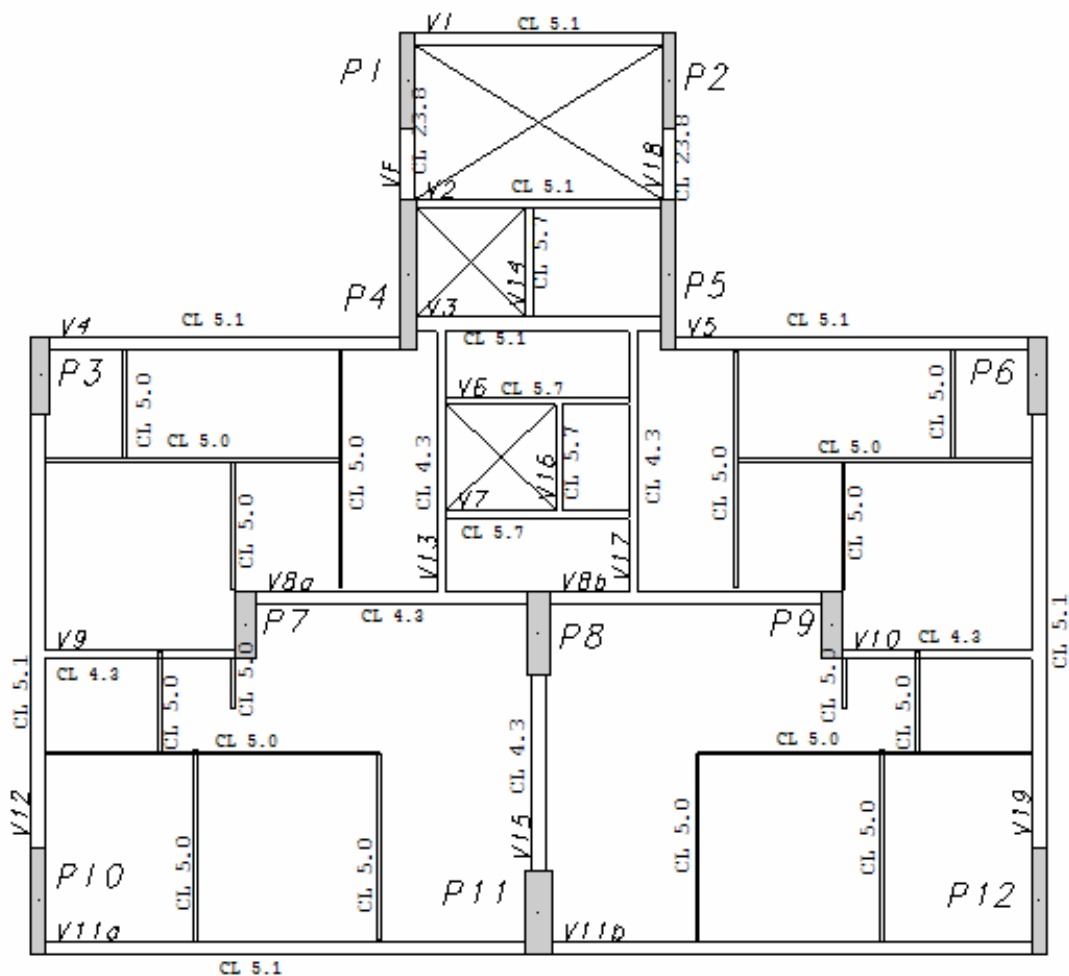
Cargas distribuídas sobre lajes e vigas
